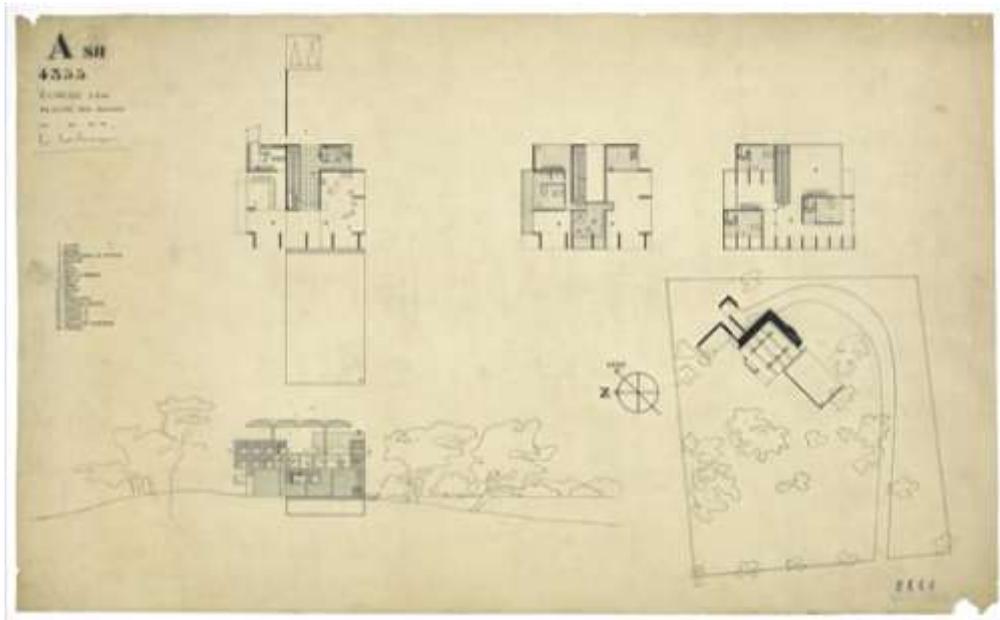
FLC 6444a Echelle 1/200e Plan du RDC avec piscine, plans niveaux 1 et 2, élévation, plan de masse orienté
